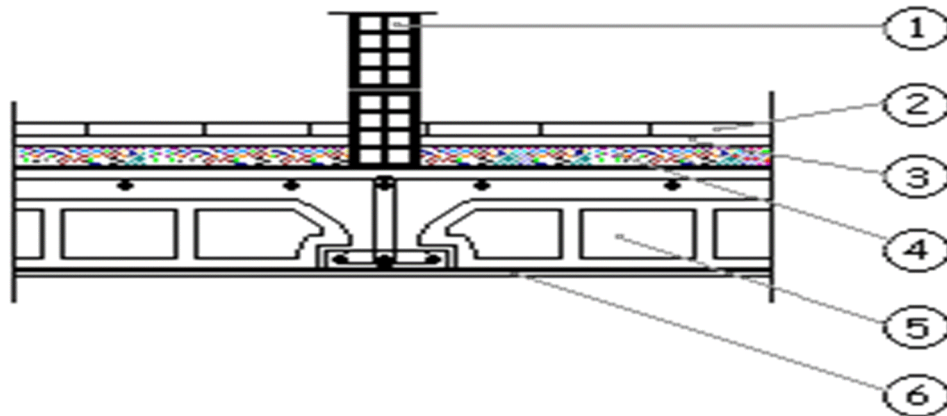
Coupe transversale du plancher terrasse inaccessible
